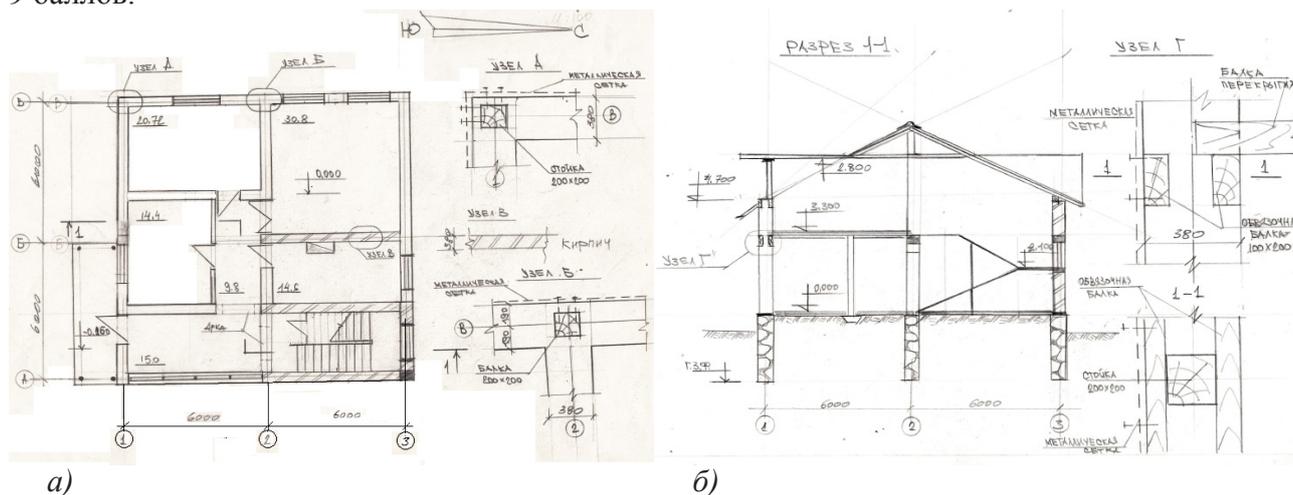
План и разрез двухэтажного жилого дома с деревянным каркасом, стены из фиброблока: а - план первого этажа, б – разрез
